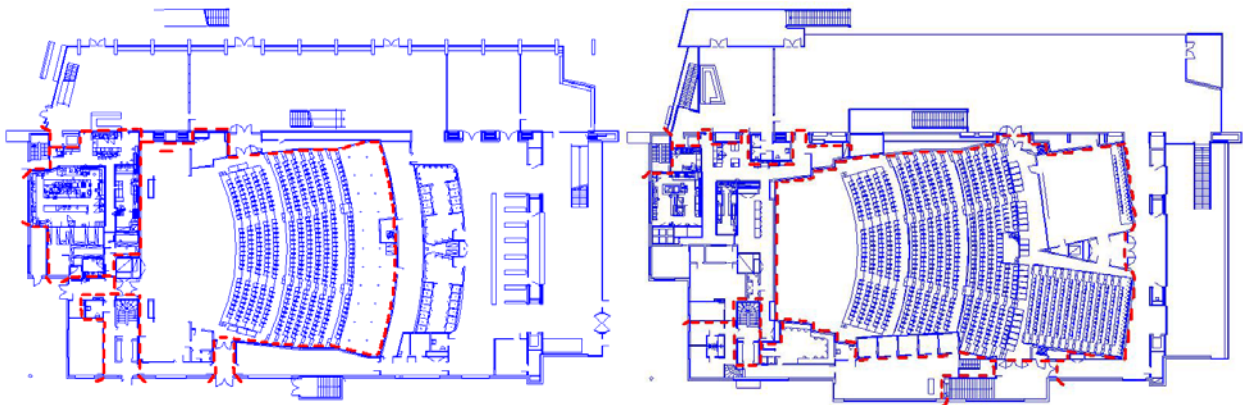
Brandcellsindelning plan 2 och plan 3.
